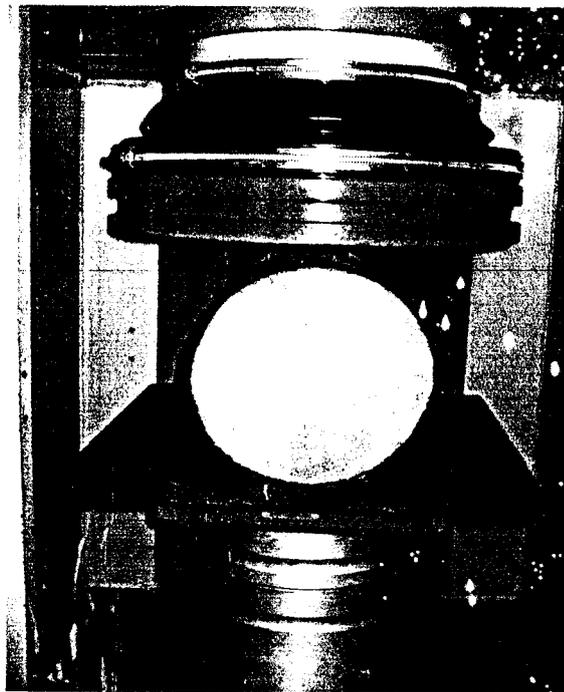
Pengujian Kuat Tarik-Belah Silinder Beton
